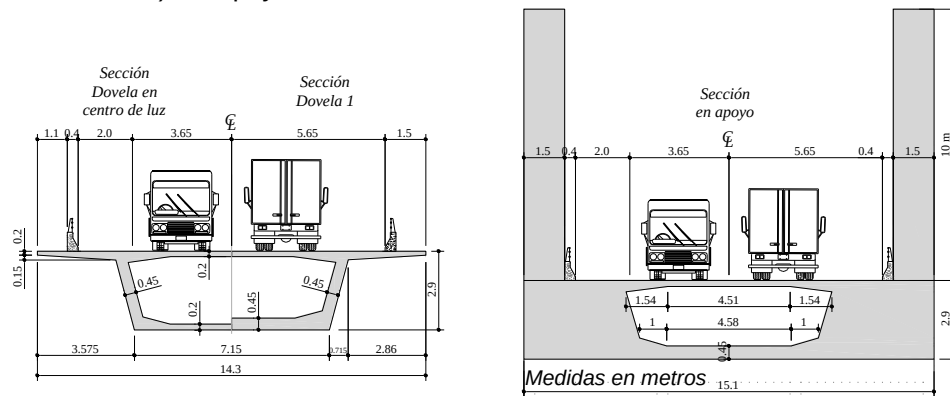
Secciones transversales del tablero para el puente L150: izquierda) Centro de luz y Dovela 1, derecha) En Apoyo.
